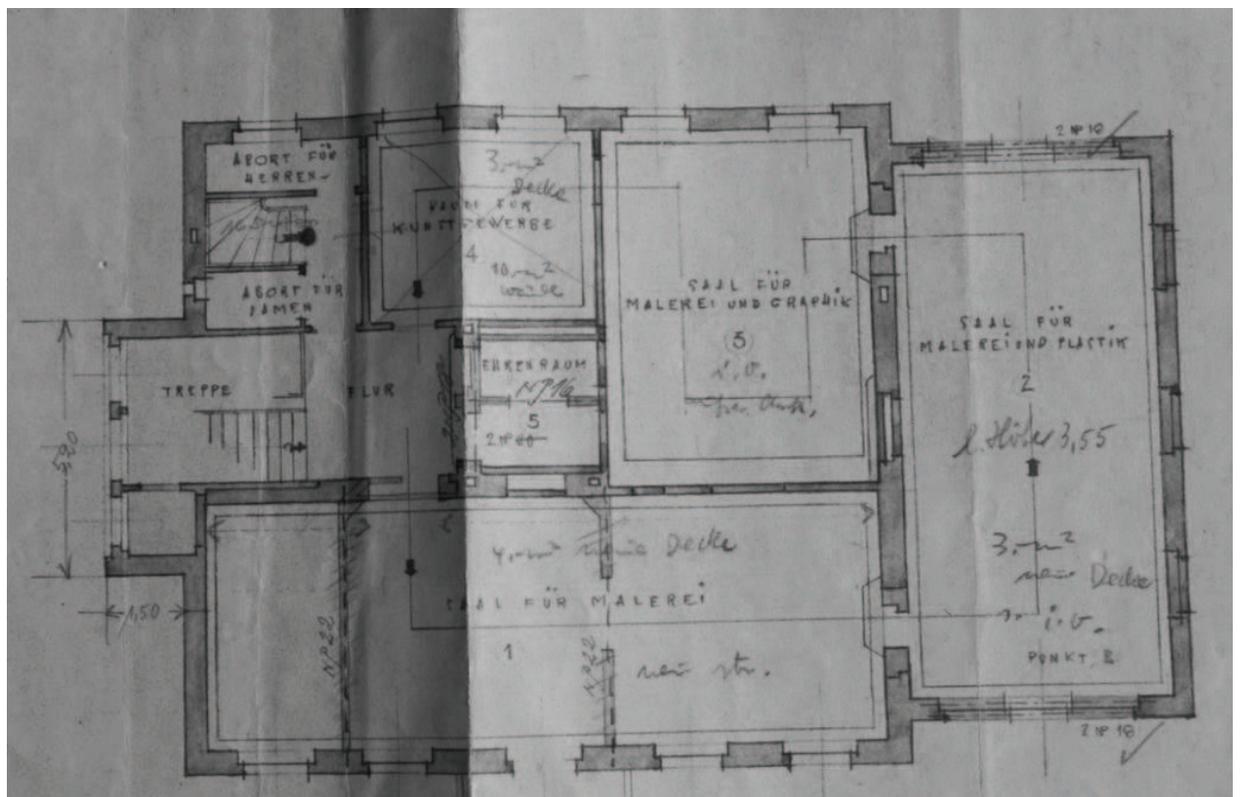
Alfred Imbery, Plan zum Umbau Königstr. 21, März 1934, M.: 1: 100, Obergeschoss, Detail (StADu 610/ 4056)
